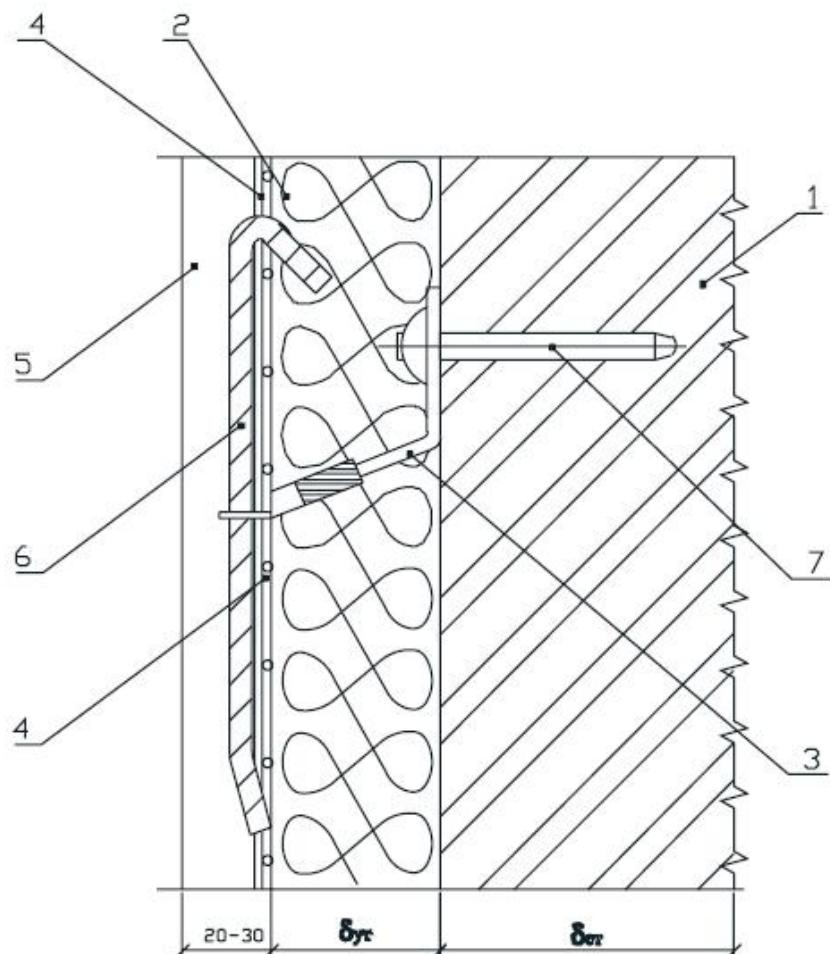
Кирпичная стена с теплоизоляцией из плит марки "ТЕРМОМОНОЛИТ" или "ТЕРМОФАСАД" со штукатурным покрытием. Верх утепления.
